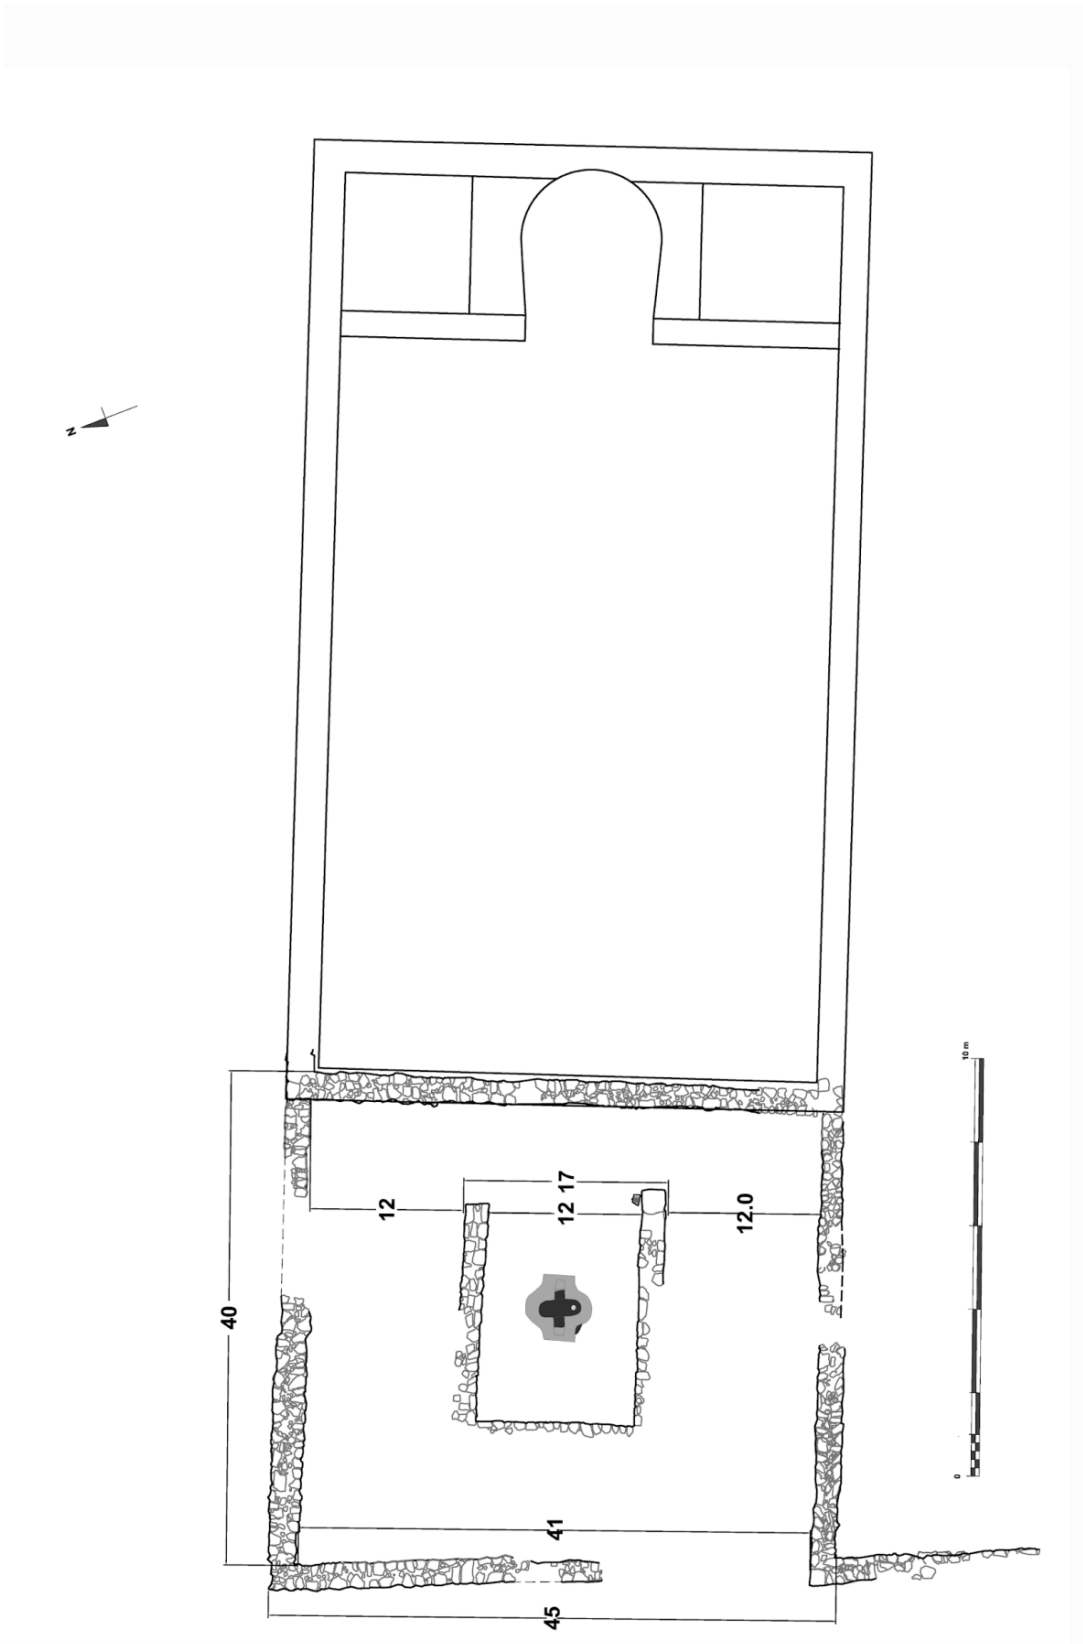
Planta del baptisterio con las principales medidas en pous
